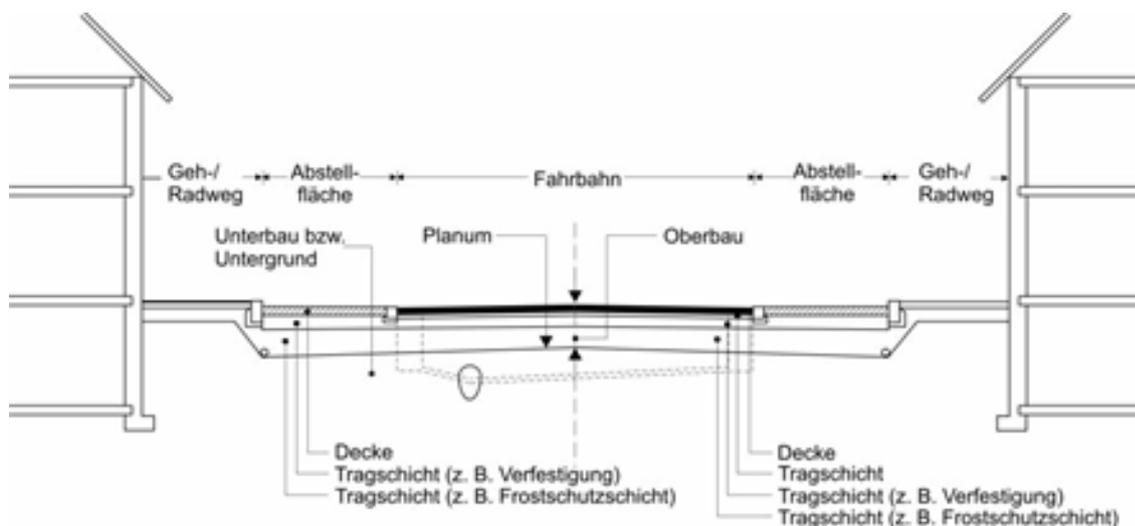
Beispielhafter Aufbau einer Befestigung in geschlossener Ortslage – wasserundurchlässig mit Entwässerungseinrichtung - gemäß RStO 12 [RStO 2012]
